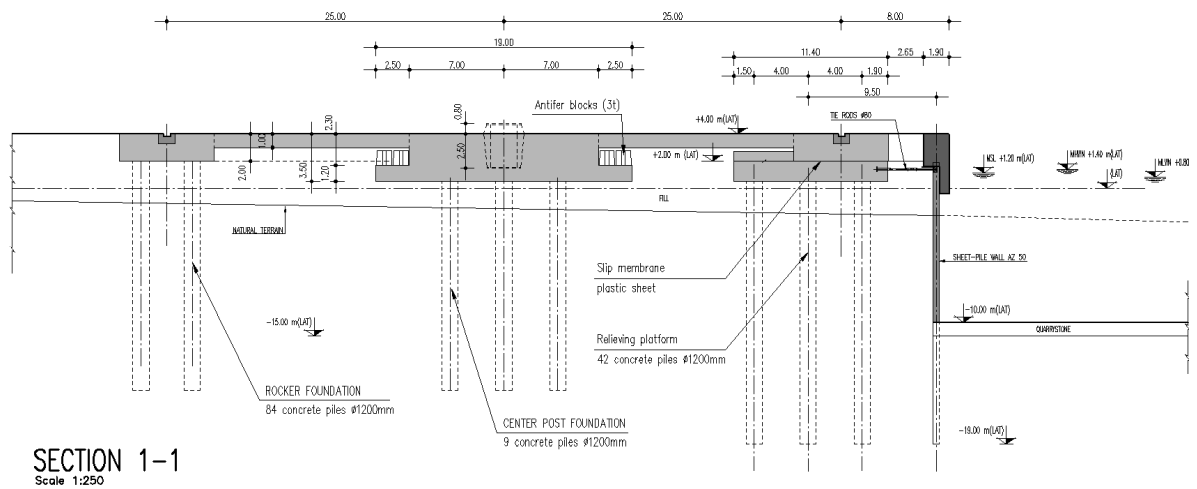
Corte pelo eixo da estrutura de fundação da HLC.
